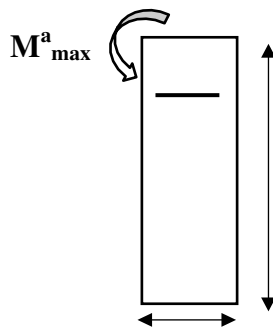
Coupe schématique de la poutrelle (appuis).
